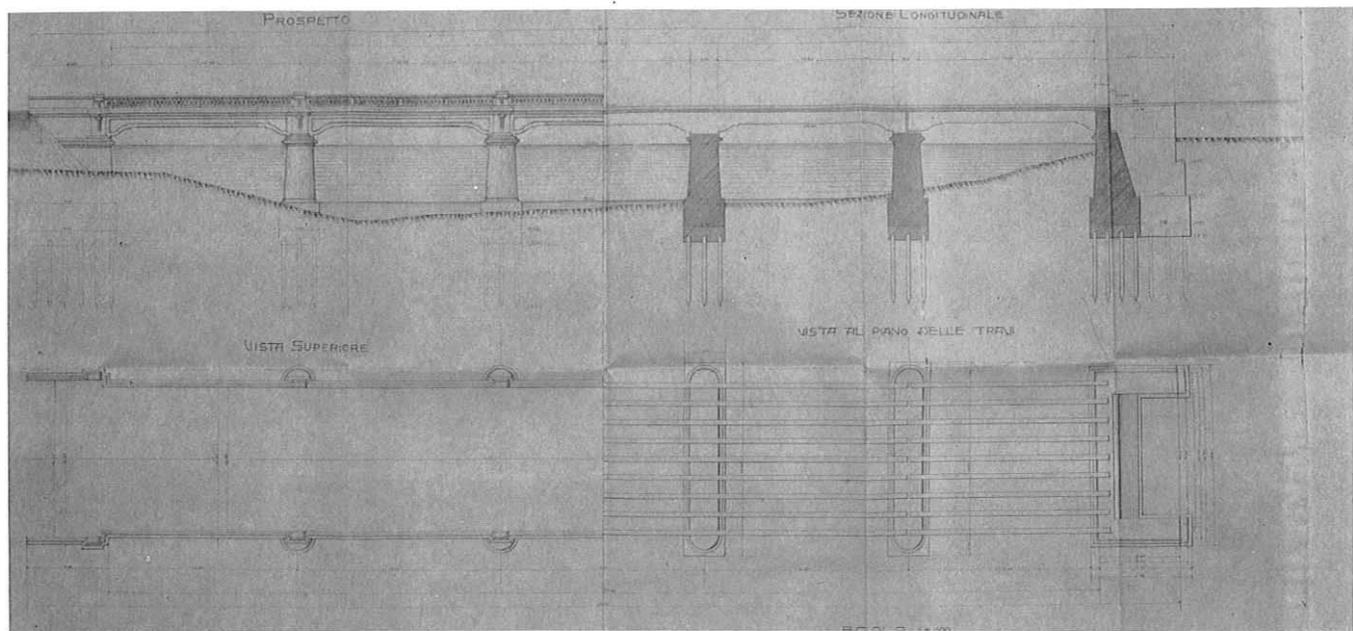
Progetto del nuovo ponte sul Savio, redatto presumibilmente nel 1913 - Prospetto e pianta.
